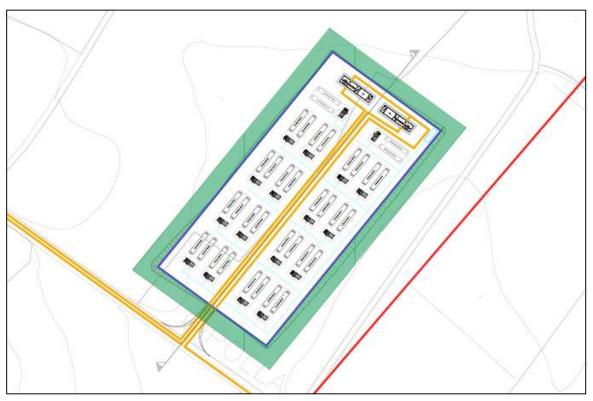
Planimetria SSEU (cfr. elaborato PD.43 "Carta della Sottostazione elettrica produttore: Planimetria e Sezione")
